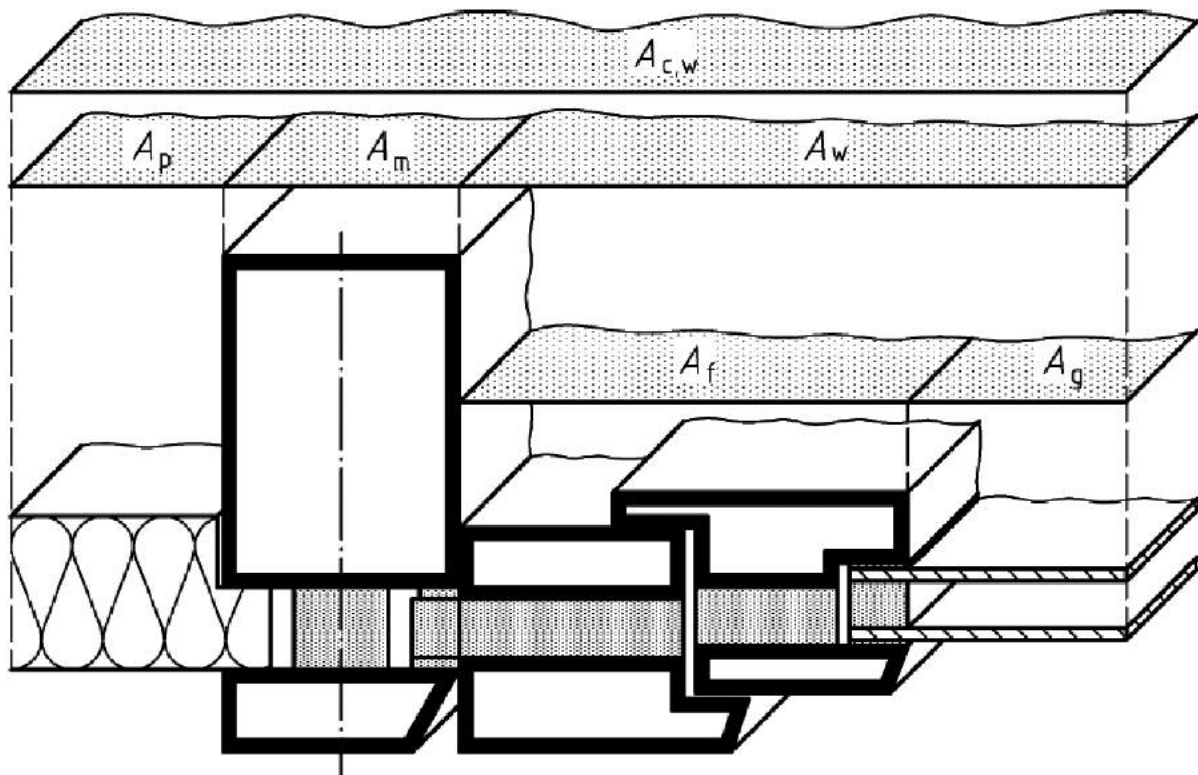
Darstellung der Projektionsflächen einer Vorhangfassade
